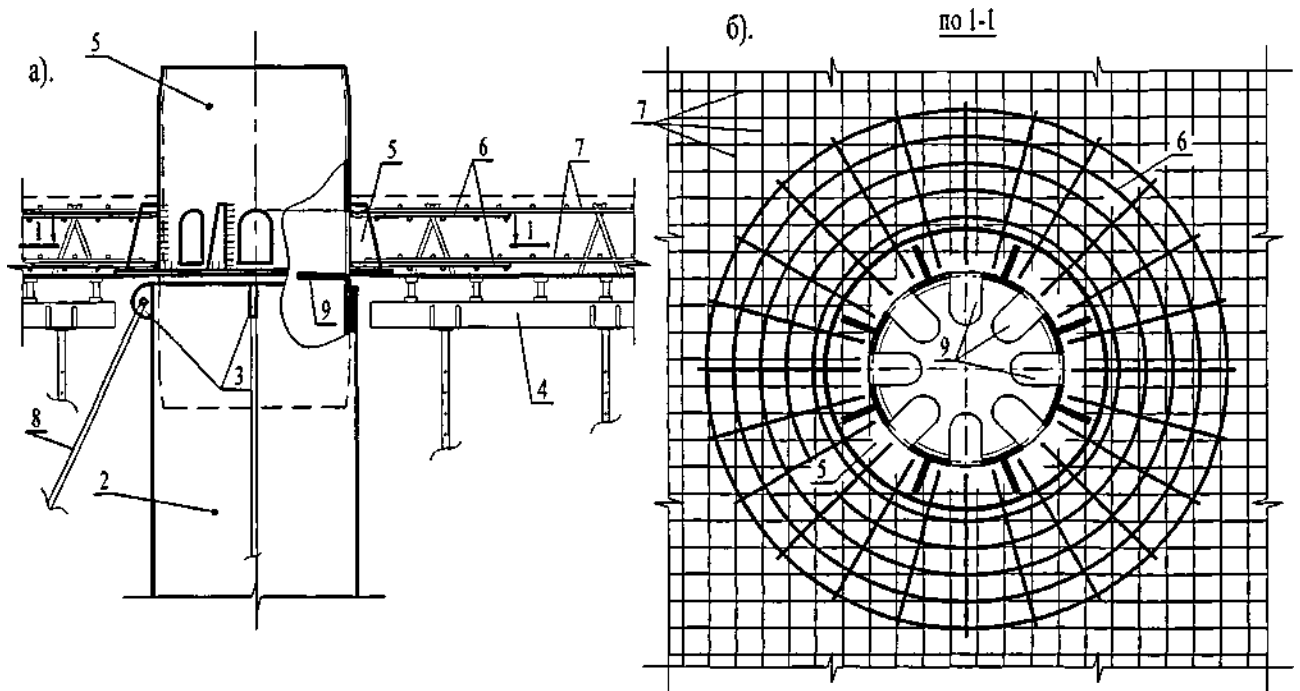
Схема влаштування балкового перекриття: 1 - сполучна гільза; 2 - сталеві оболонки; 3 - технологічні пластини («вушка»); 4 - металеві балки; 5 - зварене з'єднання; 6 - профільований настил; 7 - арматурні стержні; 8 - циліндричний пояс; 9 - монтажний підкіс
